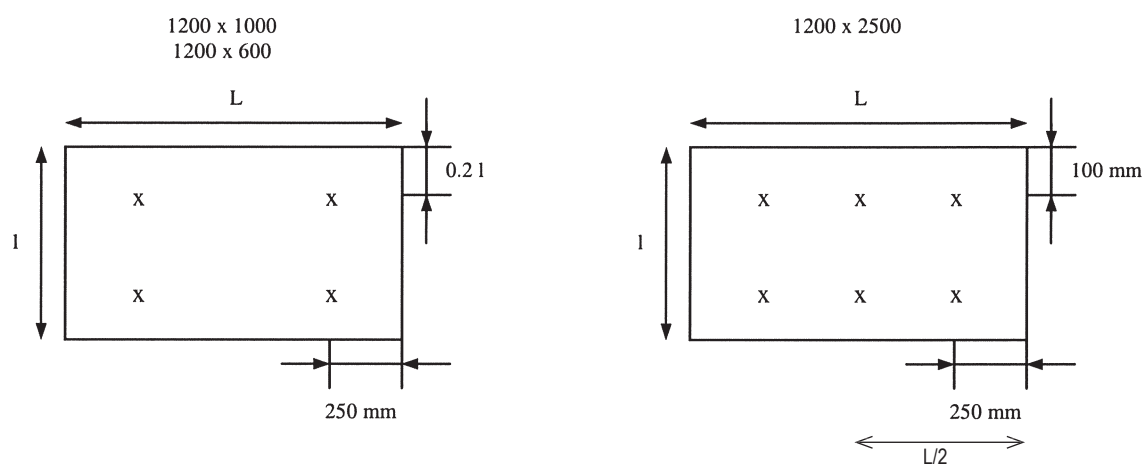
Plaatsing bevestigings voor mechanisch bevestigde platen
